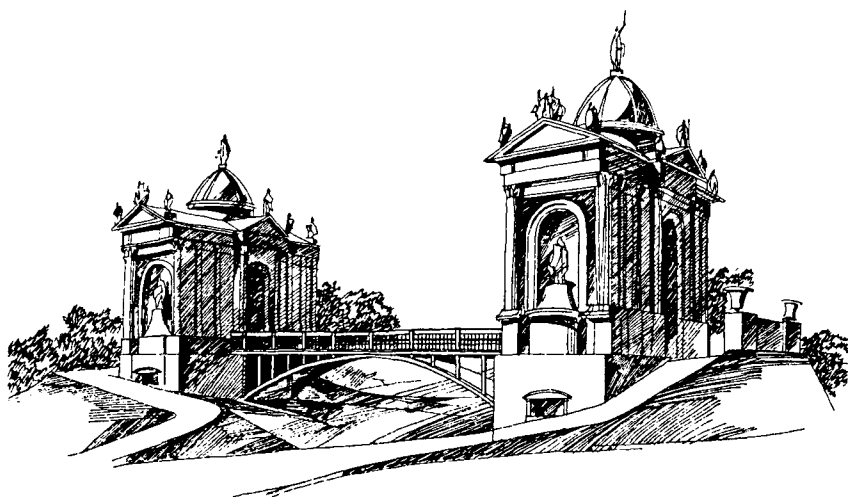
Пешеходный мост из железобетона на Нижегородской ярмарке, 1896 г.
